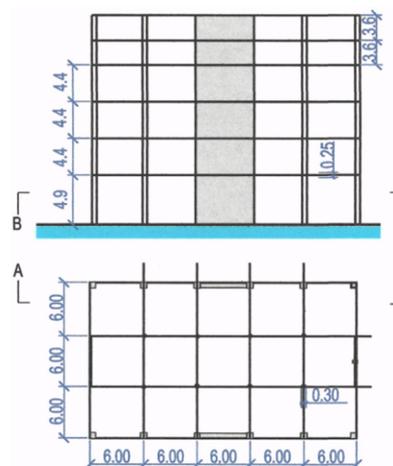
Идеальное здание с рамно-связевым каркасом
